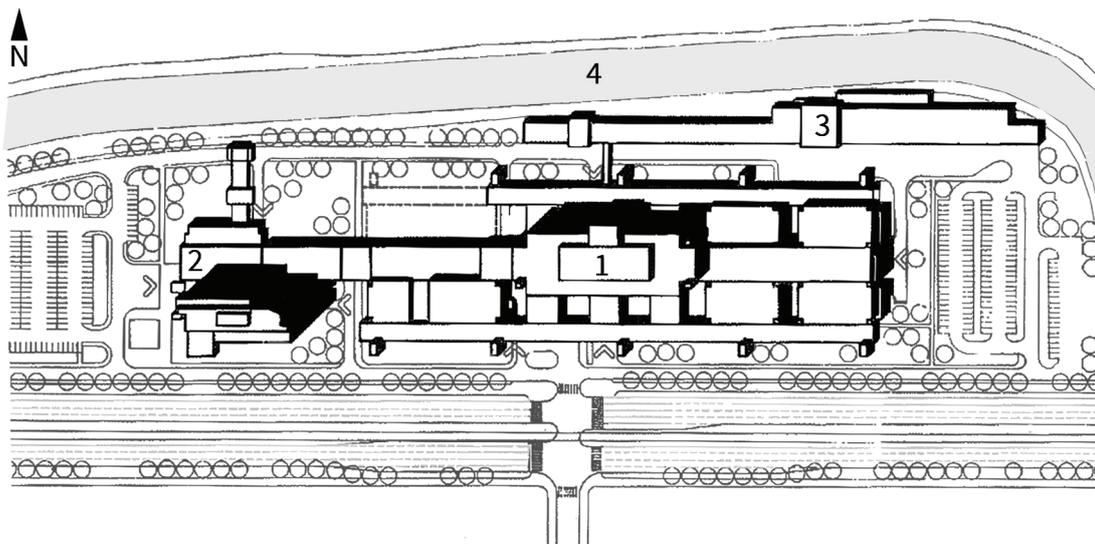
Rundfunkgebäude, Lageplan, 1983
